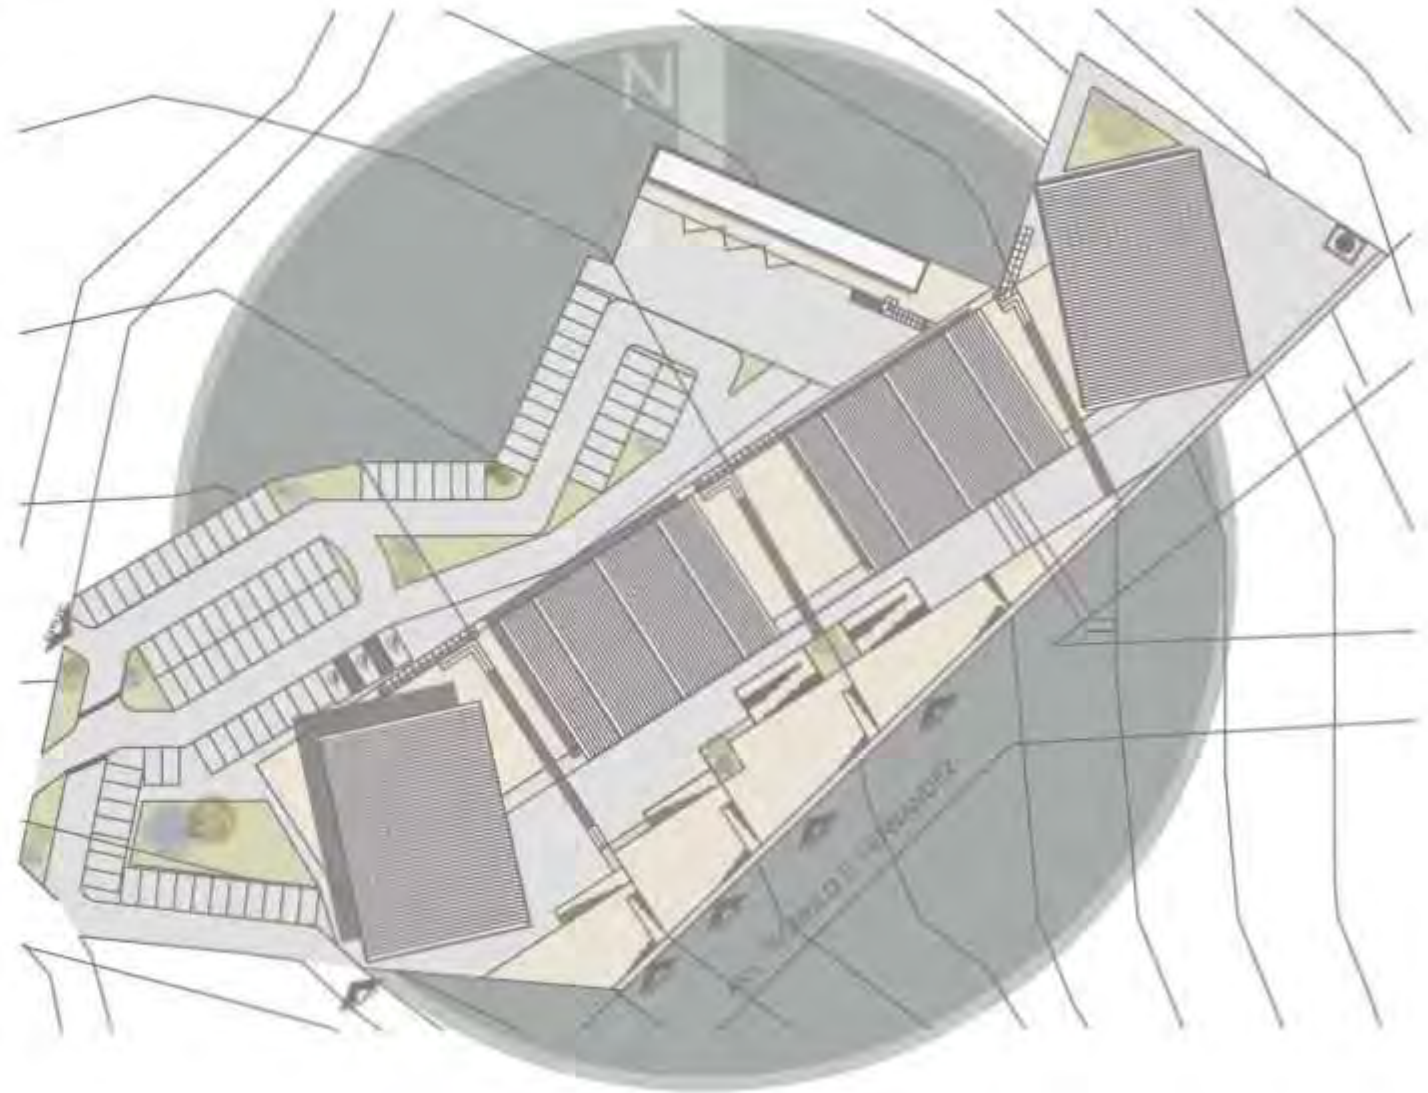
Planta de Conjunto Arquitectónica (Elaboración propia)
